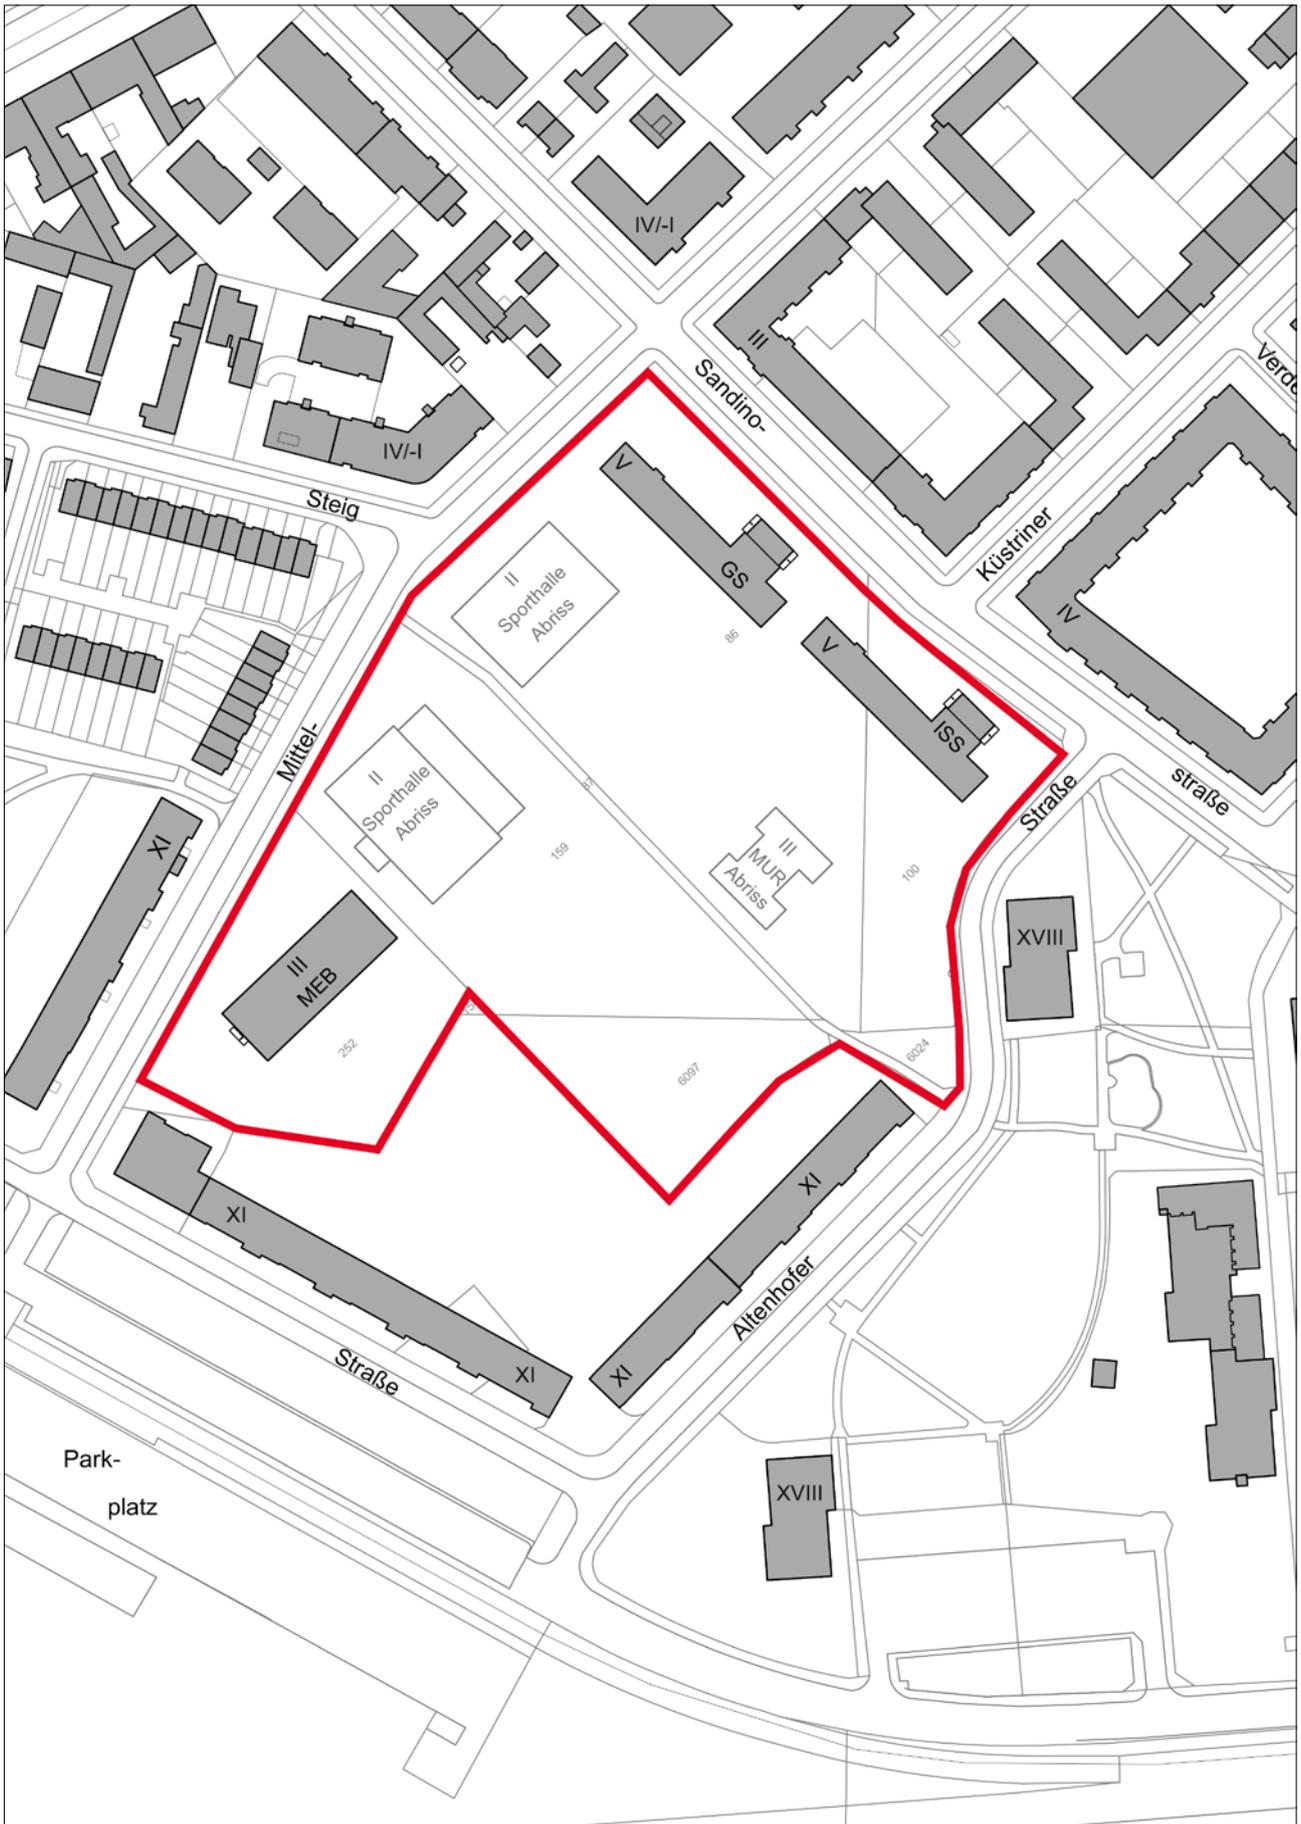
Lageplan mit Kennzeichnung des Wettbewerbsbereiches
